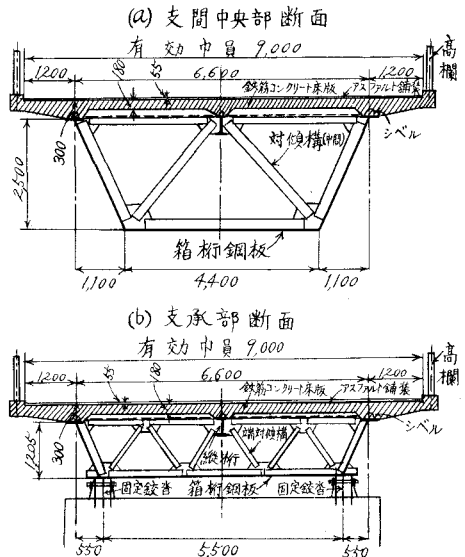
変断面合成箱桁橋の横断面図 (長さの単位: mm)
